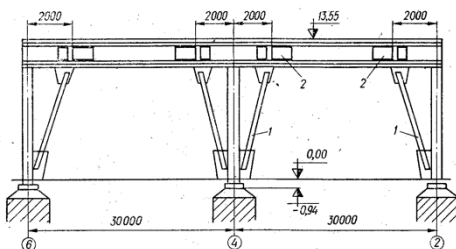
Усиление подкрановой эстакады: 1 – подкосы усиления; 2 – усиление стенок балок ребрами жесткости.
